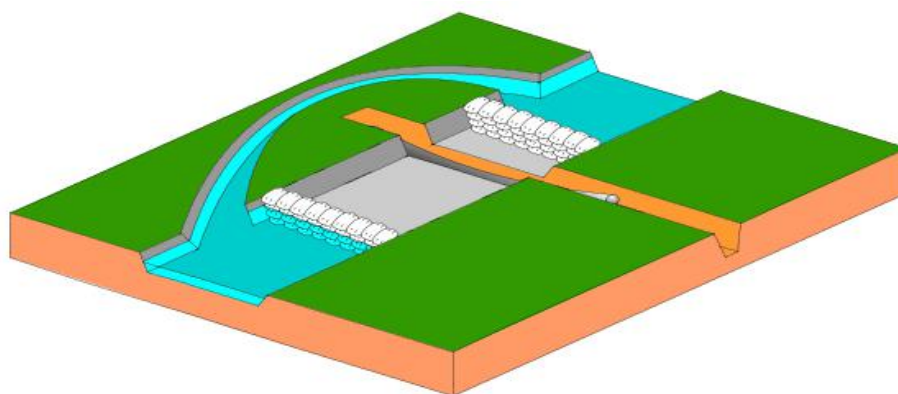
围堰导流开挖管沟法施工断面示意图
